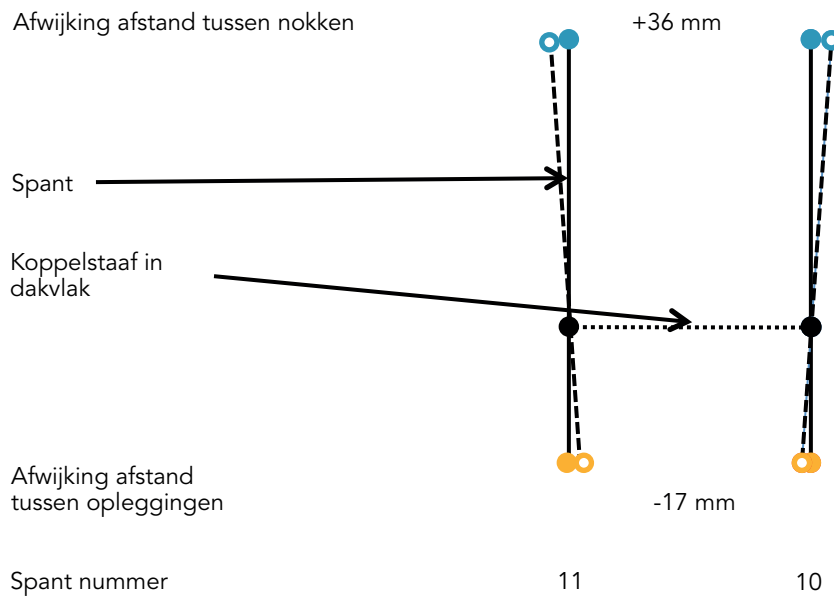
Afwijkingen in de horizontale afstand (x,y) tussen hoeken van de betonconstructie ter hoogte van de opleggingen op de tribune¹¹⁰
